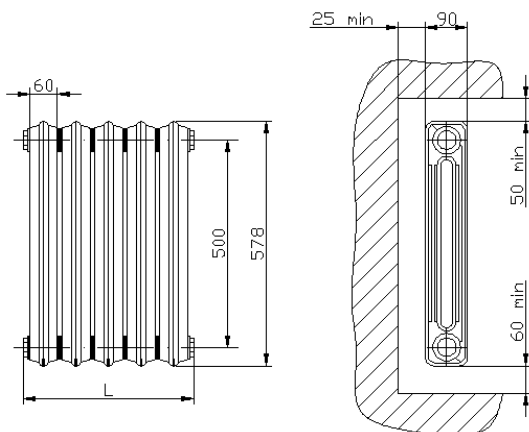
Чугунный нагревательный прибор 2КП-90×500:
